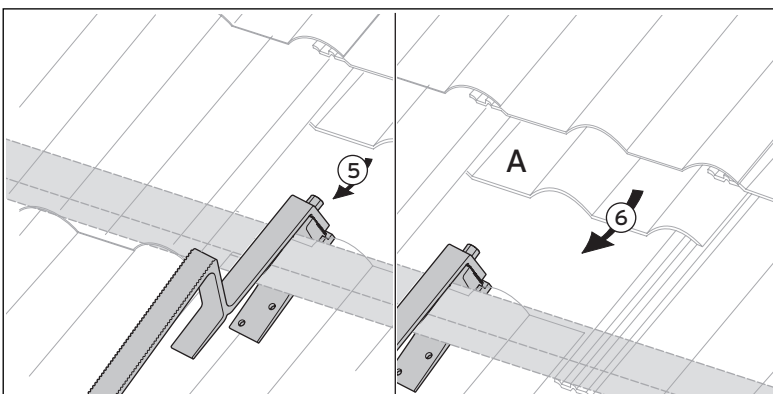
Dachanker Typ P an der Dachlatte befestigen
